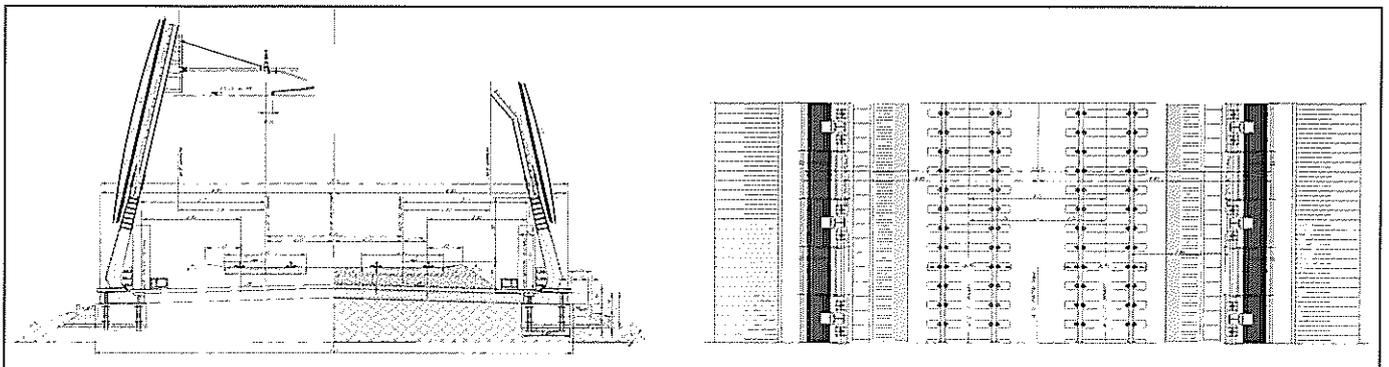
Sezione Tipo doppio binario in Rilevato con Barriere Antirumore
